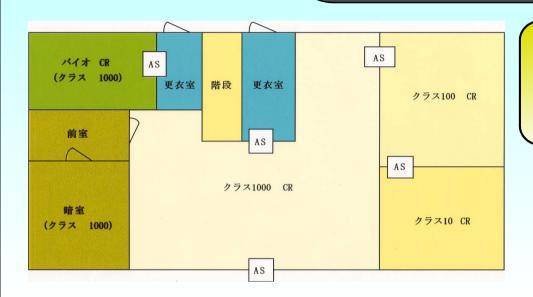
放射化学実験棟 1階平面図 1:356 (変更後)
